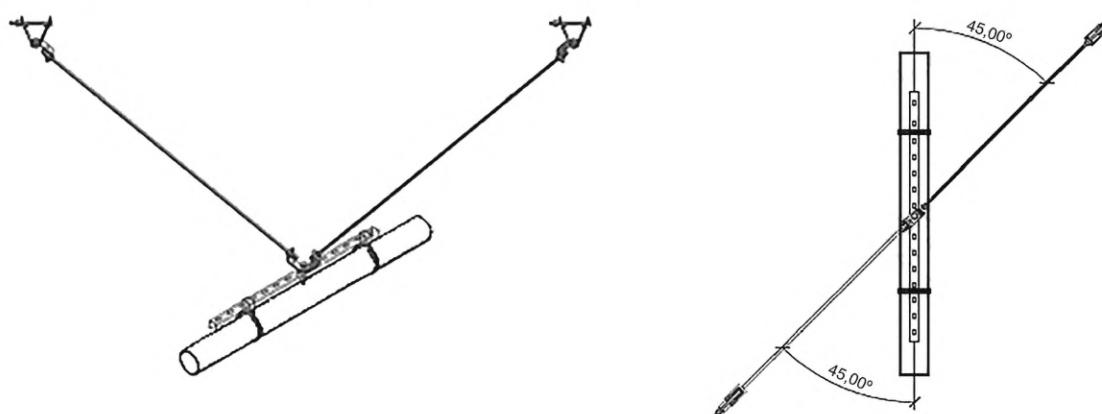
Дополнительные крепления горизонтального трубопровода ССВК
